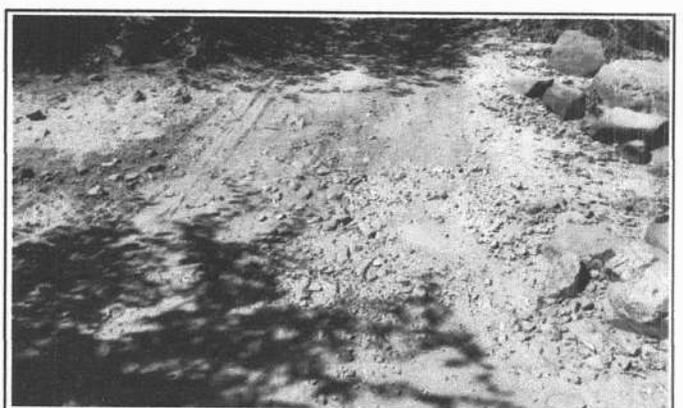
LOCAL DA CONSTRUÇÃO- BUEIRO
